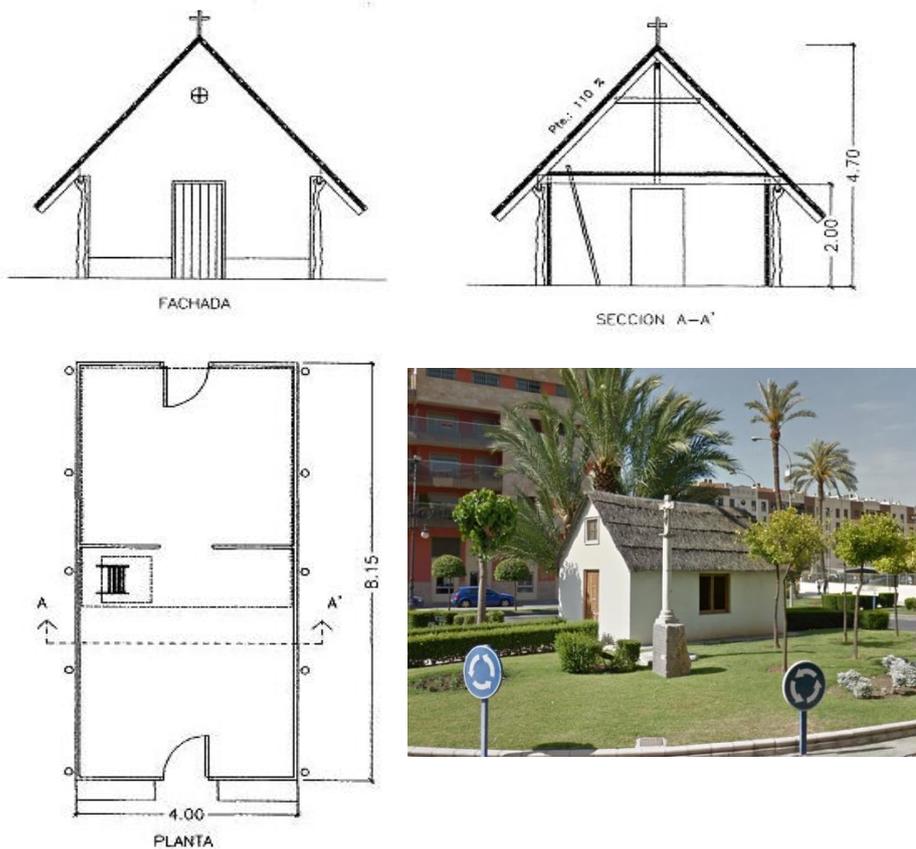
Variantes constructivas de las Barracas. Ferre de Merlo, Luis. García González, Encarnación. Foto: streetwiev
